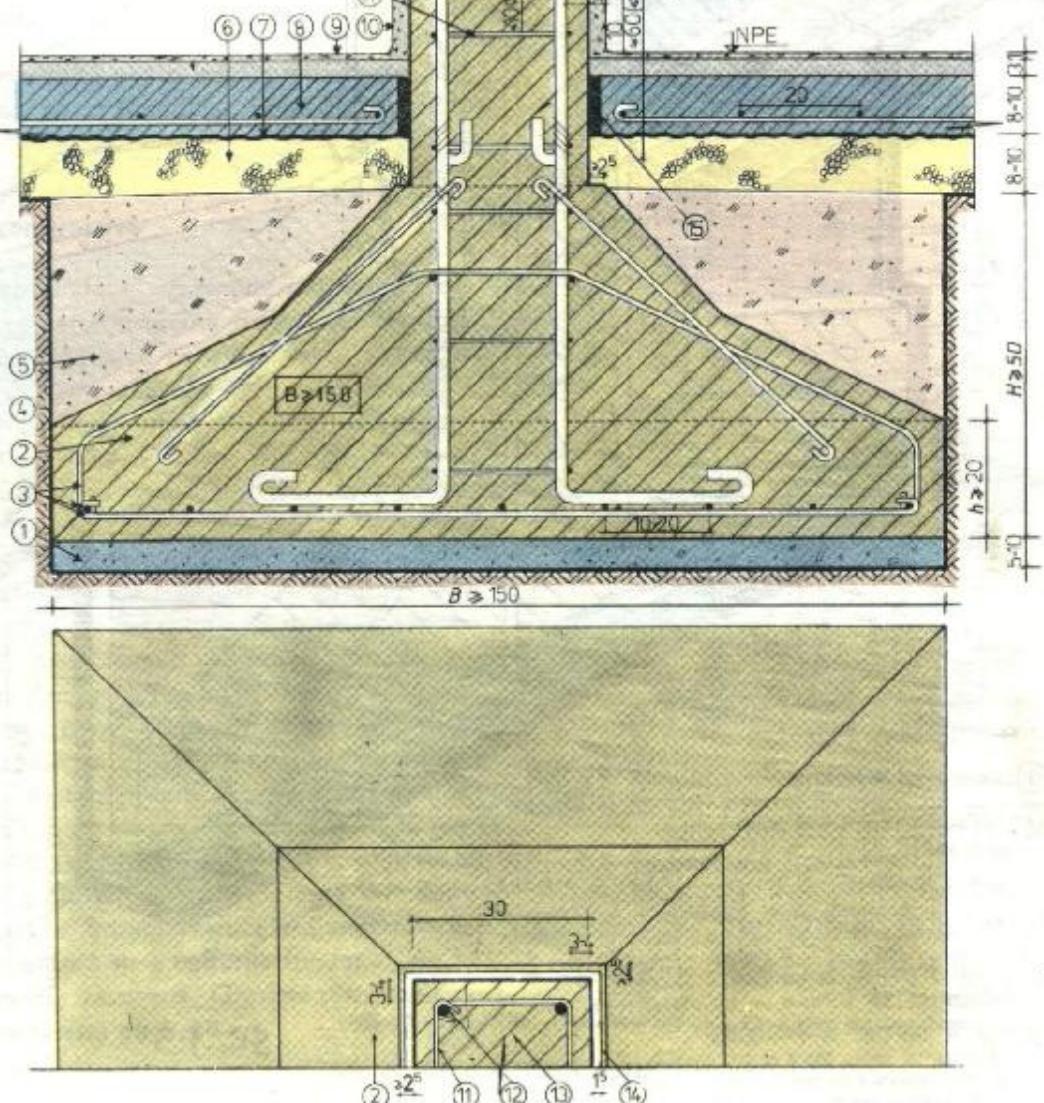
Fundație ciupercă de beton armat, sub stîlp de beton armat. Secțiune transversală:
